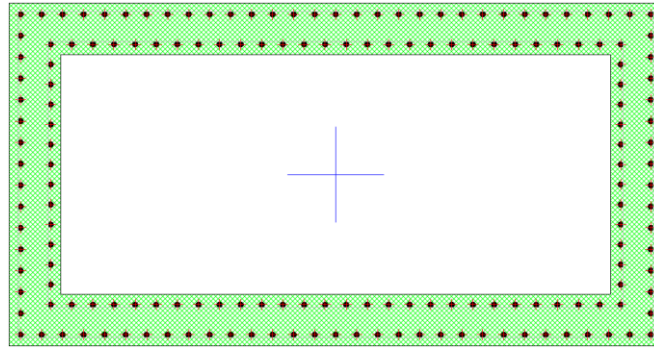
Sección A (3,80 m x 2,00 m) con armadura longitudinal (cuantía 4,30%)
